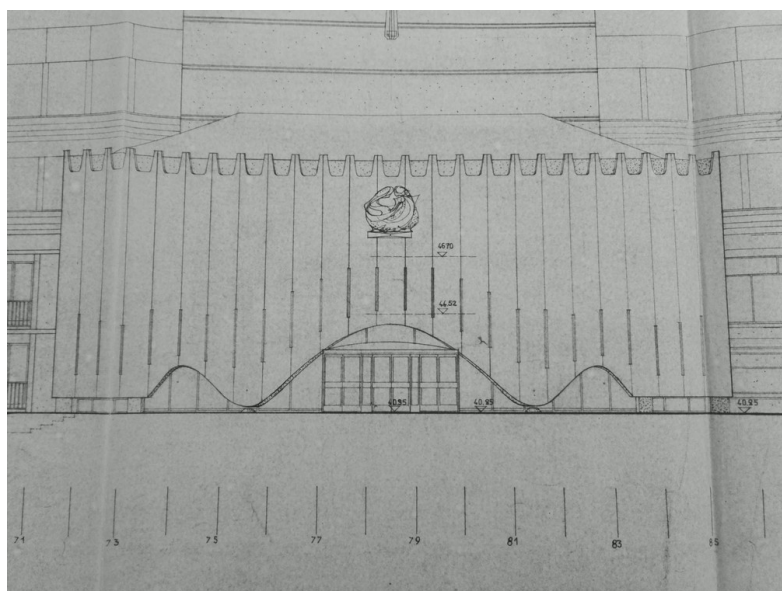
Façade est. Louis Arretche et Patrick Coué. 15 mai 1964. ADIV1307W60
